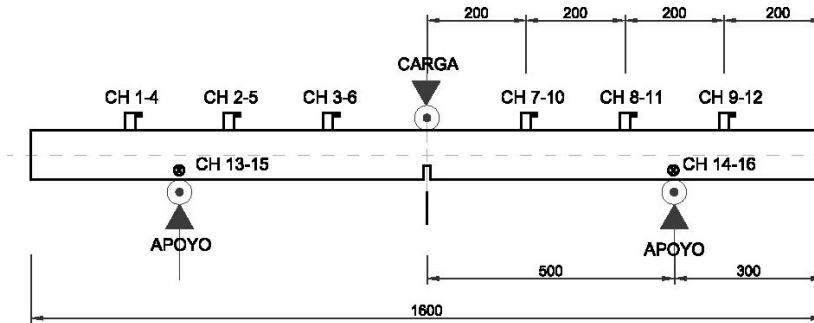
Ubicación de los sensores de EA en las vigas con muesca. Origen de coordenadas en el centro de la viga. Distancias en mm.
